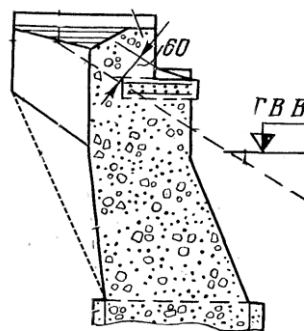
Схема укладки железобетонных коробов на переходных участках моста
